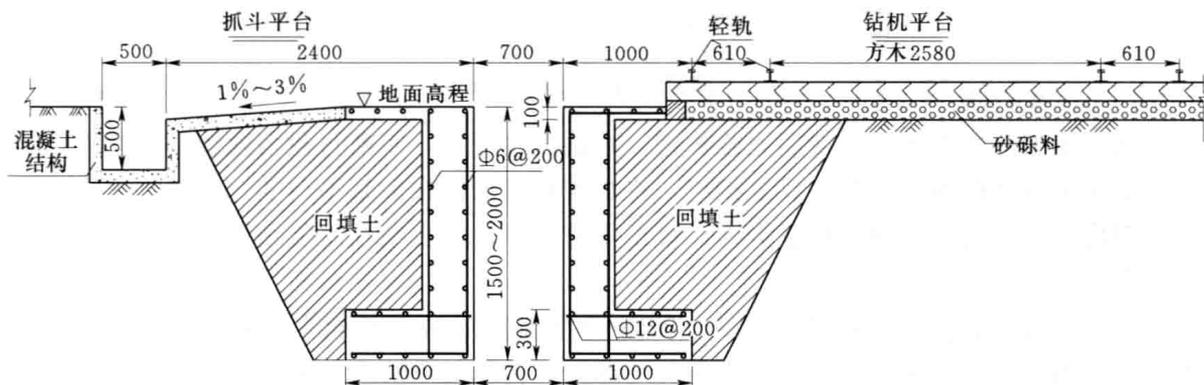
副坝段防渗墙导墙及施工平台断面图（单位：mm）
